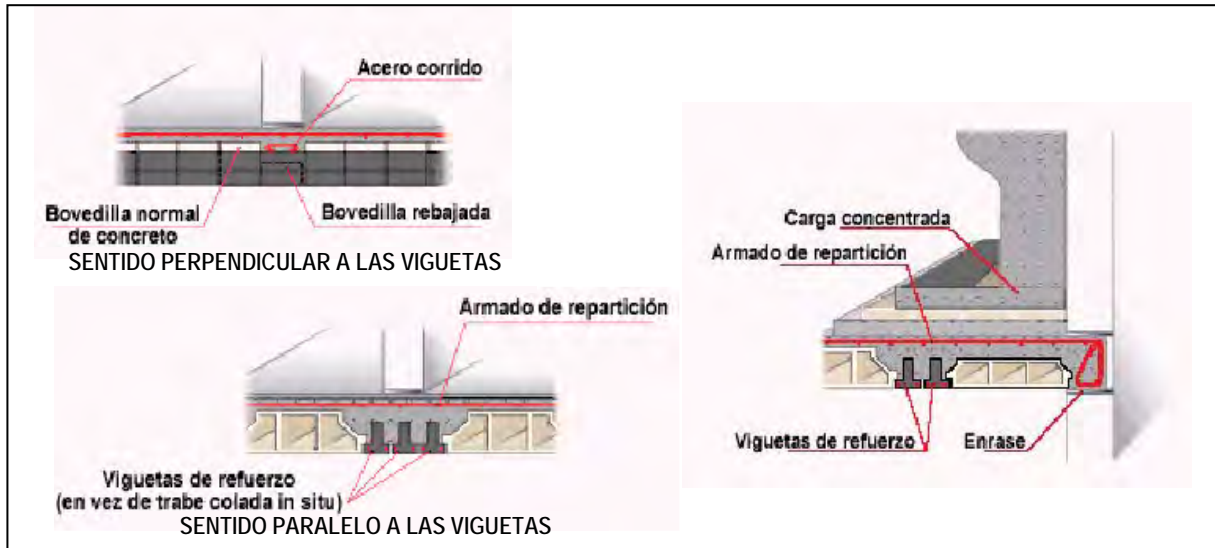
SOLUCIONES DE REFUERZO CON VIGUETAS PARA SOBRECARGAS LONGITUDINALES O PUNTUALES
